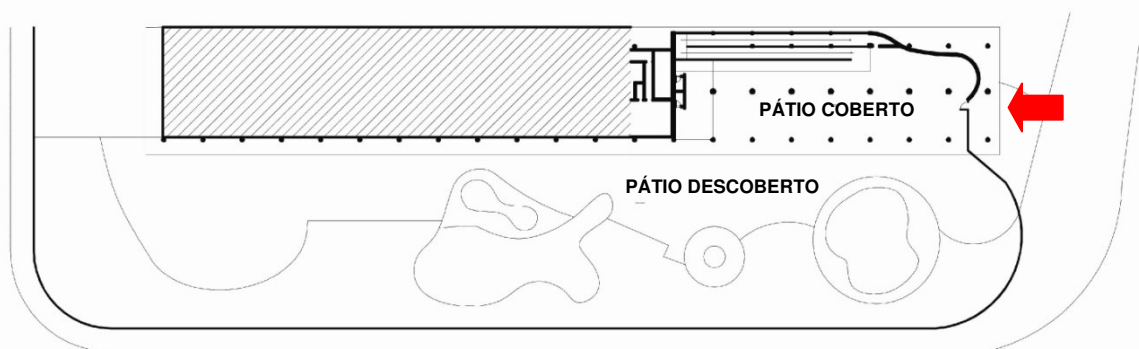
planta baixa do primeiro pavimento do Bloco D do IPPMG, onde situa-se o acesso e as áreas de recreação da EEI-UFRJ. A seta em vermelho indica o acesso principal do edifício. Sem escala.
